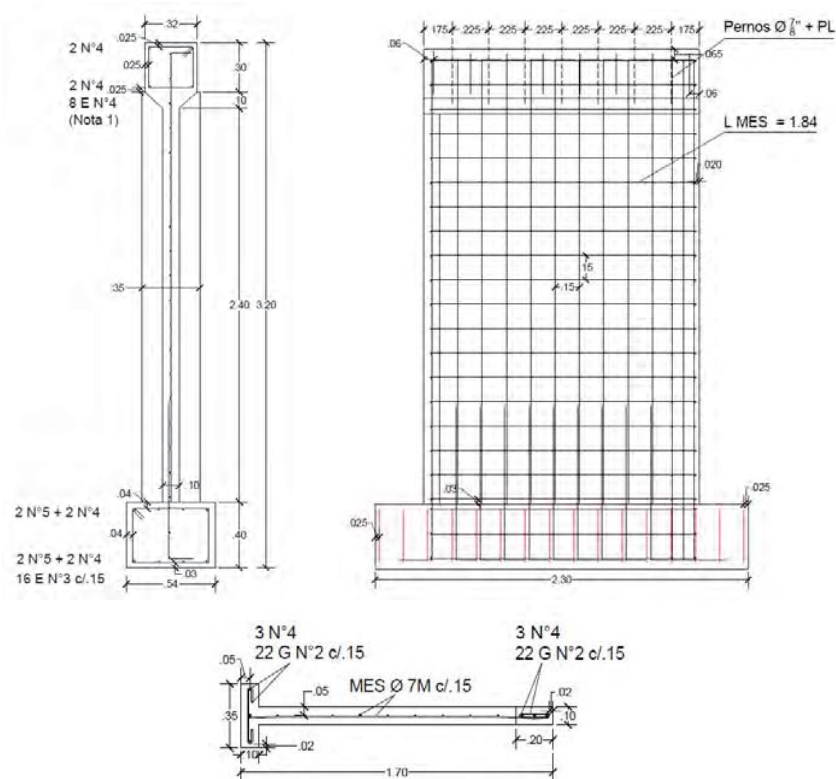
Especificaciones Probeta de MDCR: a) Vista lateral; b) Vista frontal; c) Vista en planta
